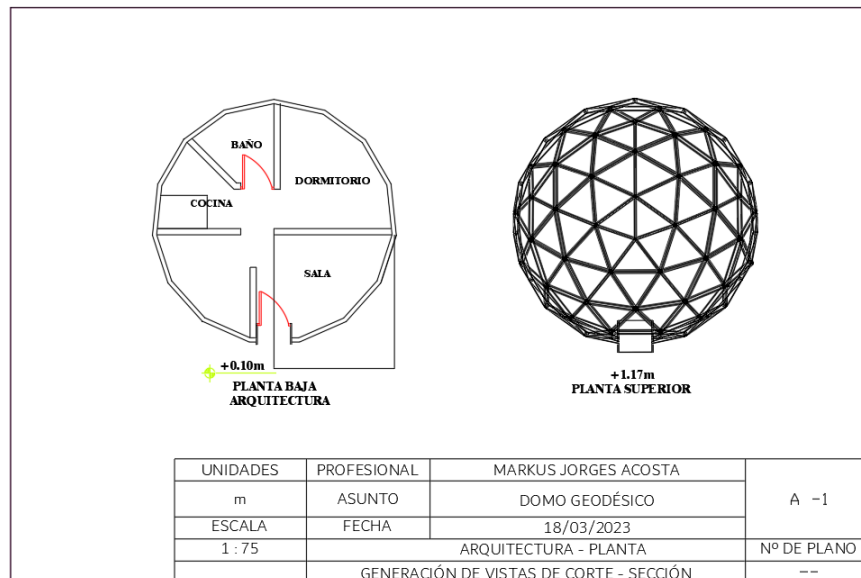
Distribución y vista de planta de la vivienda geodésica (fuente propia).
